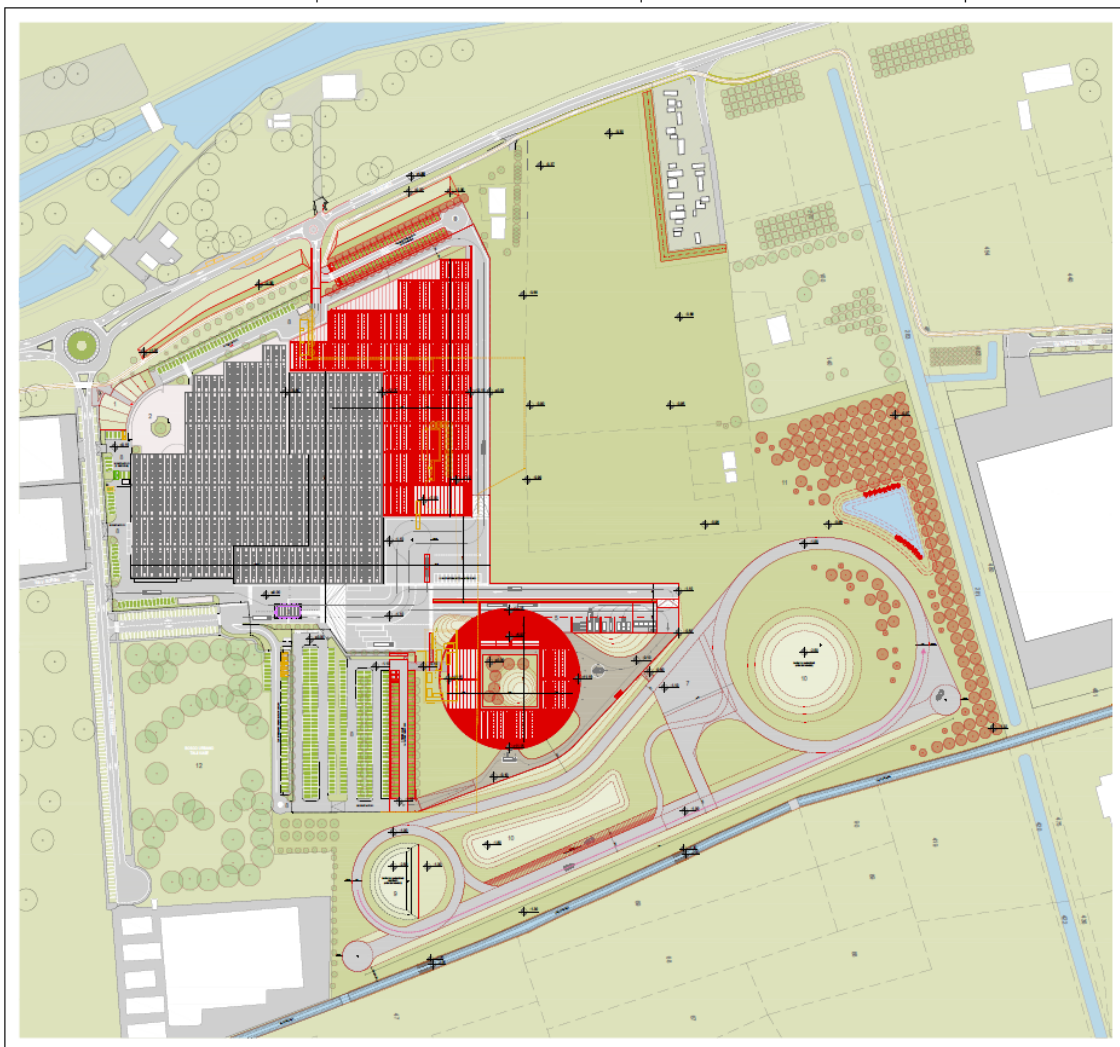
Stralcio tavola *"C ART 53 30_Planimetria Generale"*.
